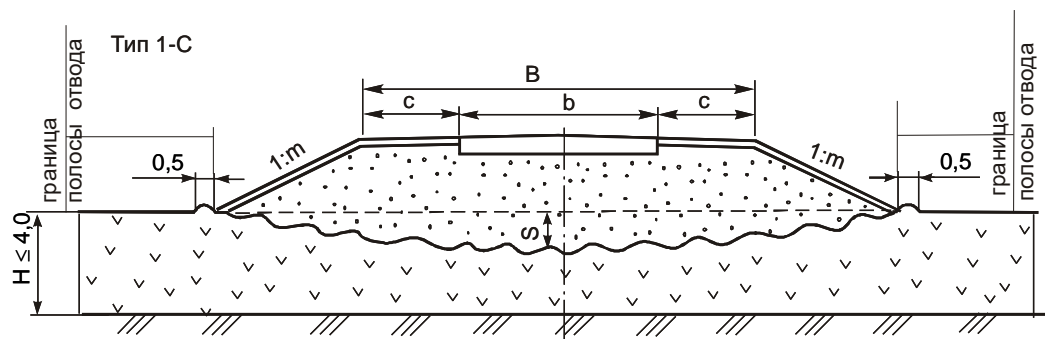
Насыпи на болотах с поперечным уклоном дна 1:10 и более
